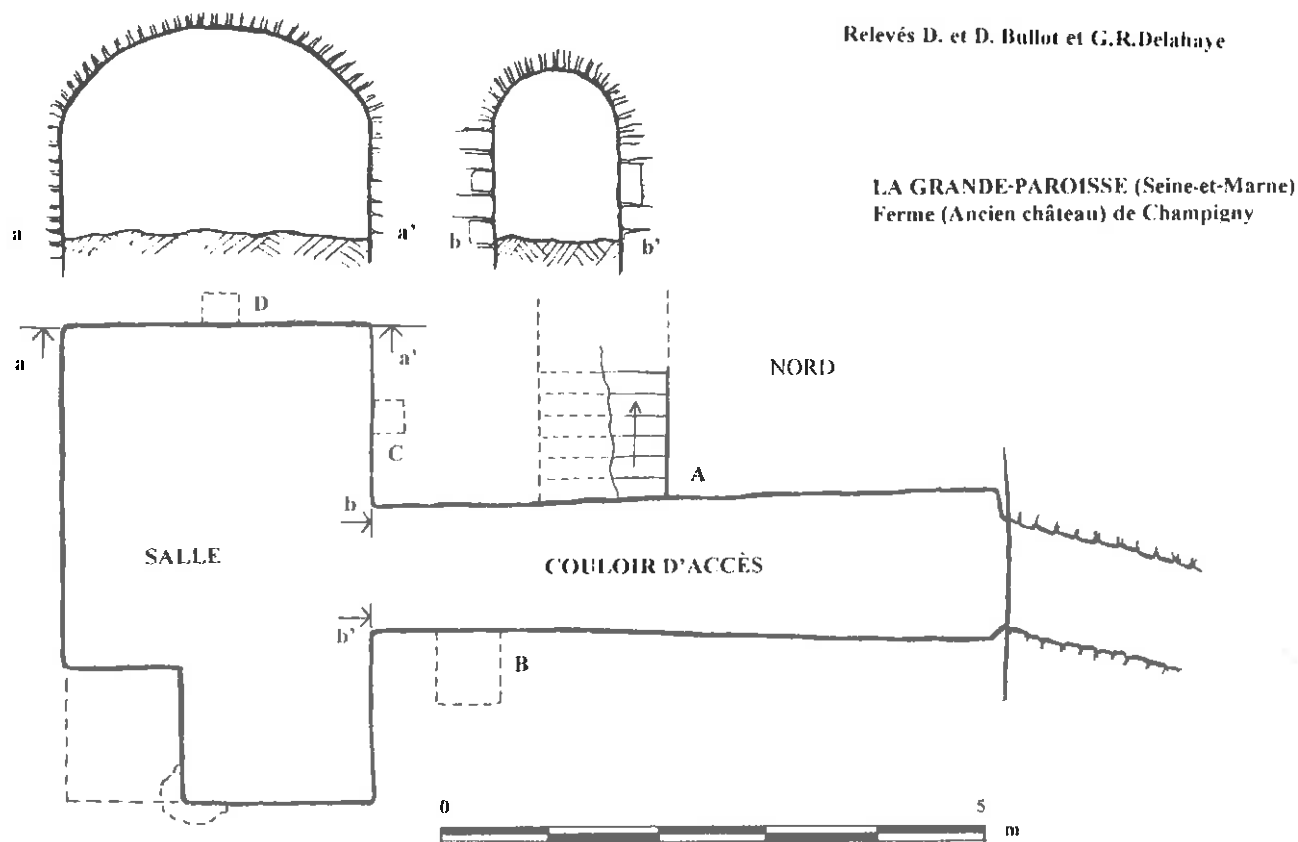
Plan et coupes d'une cave proche de la ferme de Champigny
